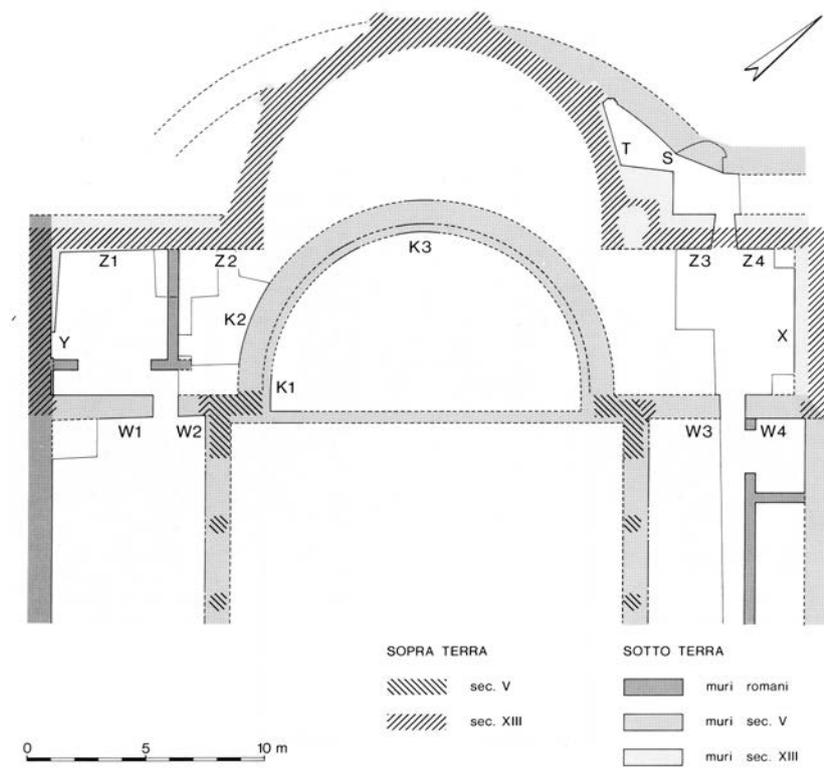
Rom, S. Maria Maggiore, Grundrissrekonstruktion mit Apsisumgang (nach De Blaauw 1994)
